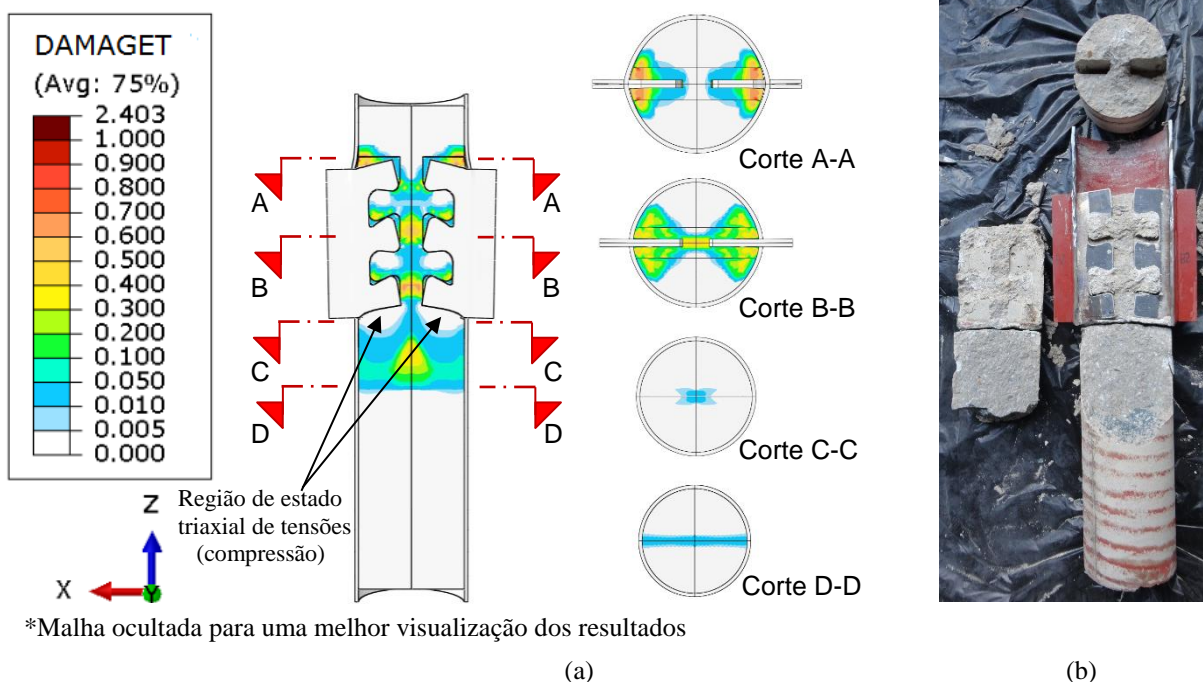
Padrão de fissuração observado: (a) modelo numérico B mostrando a variável DAMAGET no último incremento da análise, sendo ilustrada a silhueta do modelo (simetria espelhada no plano yz) e planos de cortes por nível (simetria espelhada nos planos xz e yz); (b) experimentalmente no modelo B2, através do corte e retirada do tubo de aço seguido do seu desmonte.
